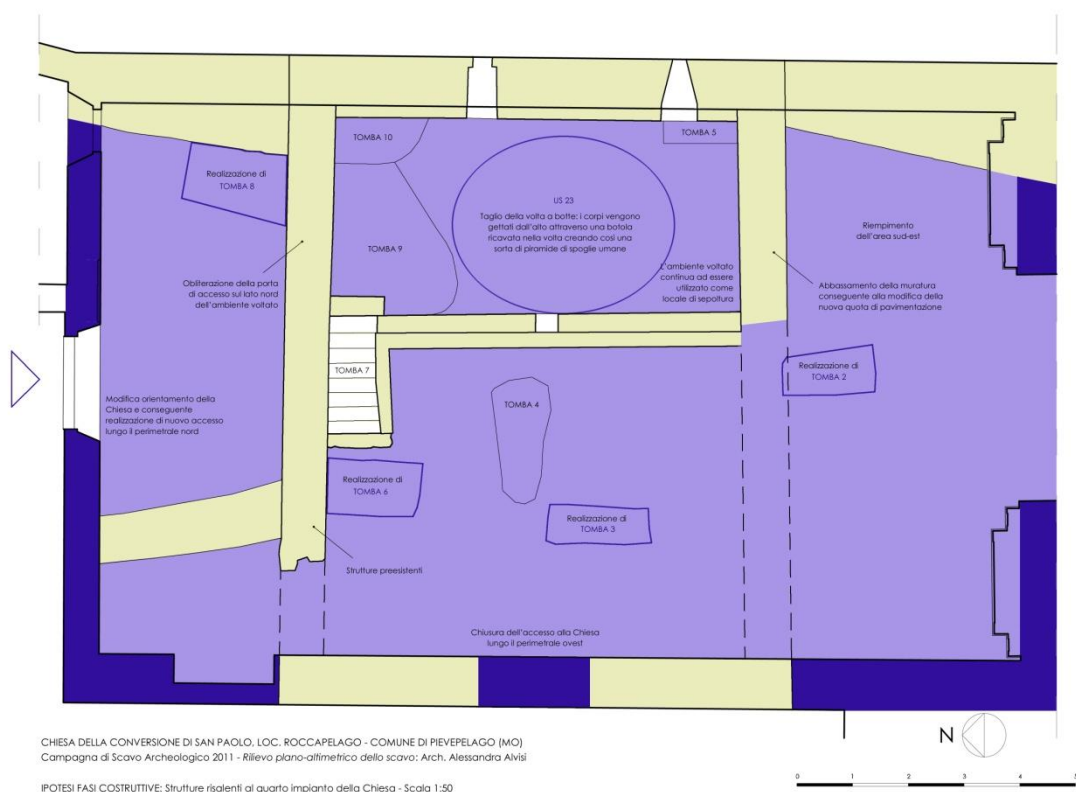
Planimetria della chiesa dopo la rotazione di 90°, le strutture castellane appaiono completamente inglobate alla struttura così modificata (foto Barbara Vernia).
